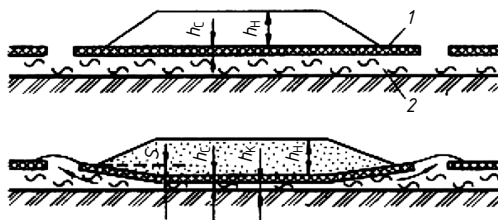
Схема посадки насыпи с подготовкой прорезей-торфоприемников: h_n — толщина насыпи; h_c — толщина уплотненного слоя болотной массы, оставшейся под насыпью; h_k — толщина сплавины; S — осадка насыпи вследствие выдавливания и уплотнения основания; 1 — промороженный слой болотной массы; 2 — талый слой болотной массы
